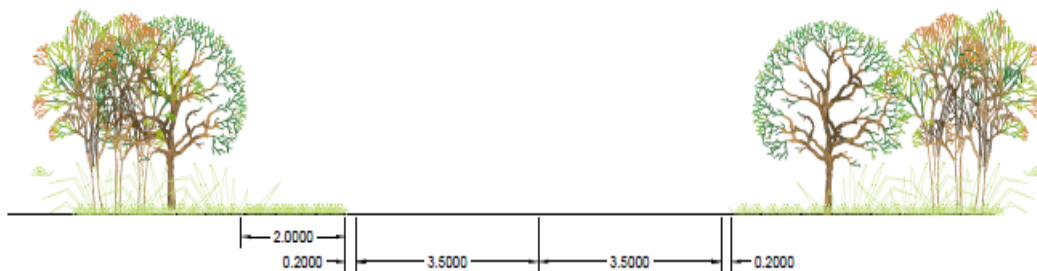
Sección transversal Tramo 1-2 Carretera vía Bejuma sector Lagunita del tramo de la curva del kilómetro 6,5 hasta el kilómetro 8.
